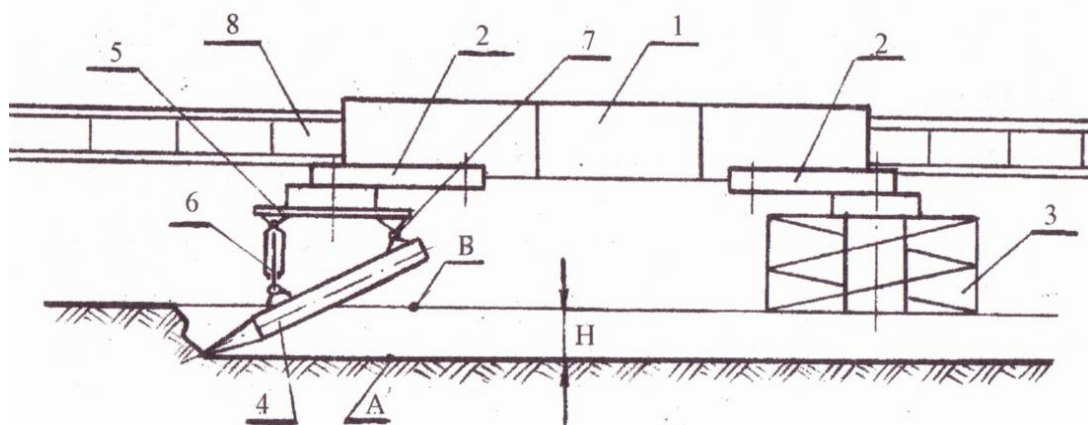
Схема компоновки комбайна с режущим и ударным исполнительными органами
